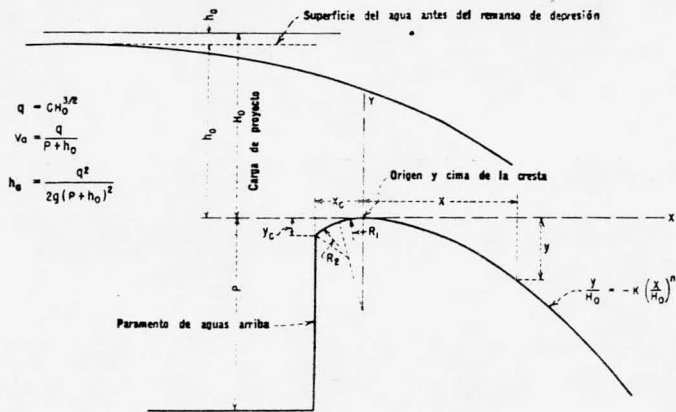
Elementos de la sección transversal de la cresta. [Ref. 3]
